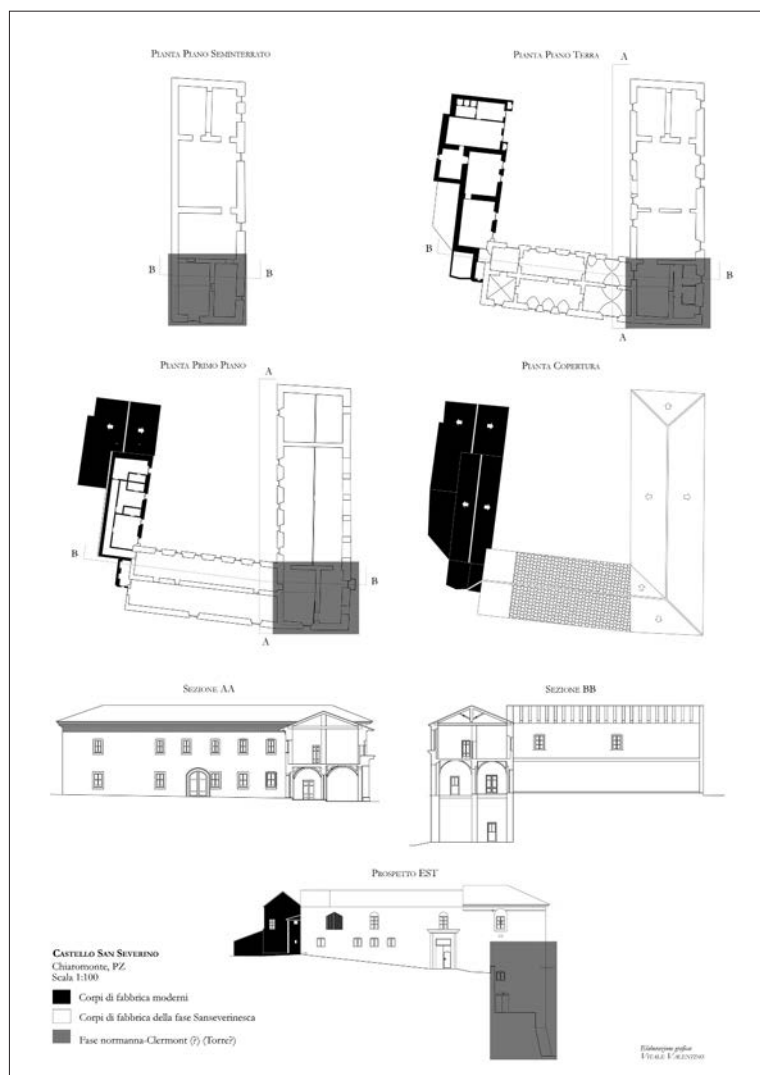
Castello Sanseverino, Chiaromonte (PZ): planimetria, prospetto e sezioni prospettiche (documentazione grafica dell'autore).
